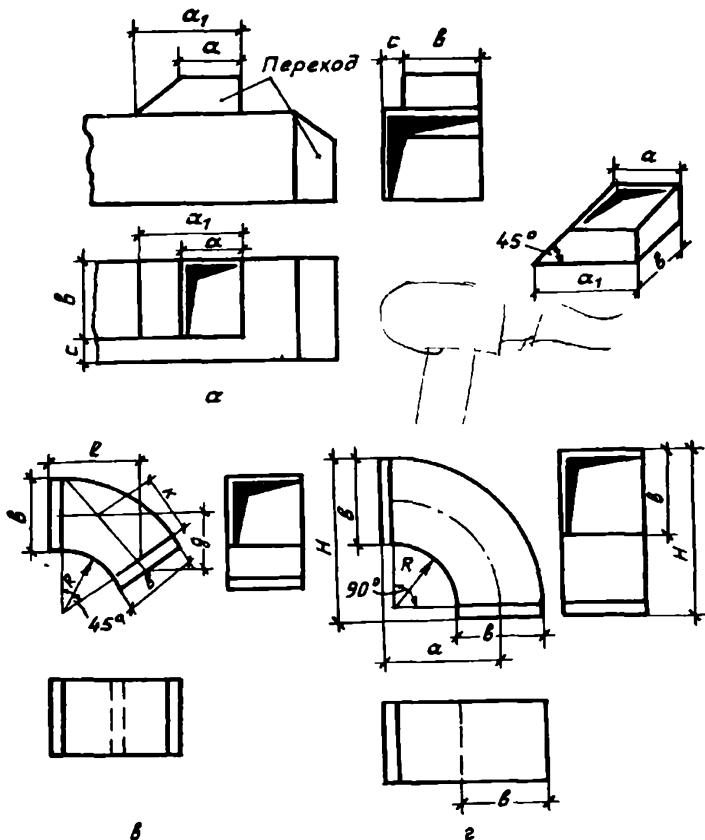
Унифицированные детали прямоугольных воздуховодов:
